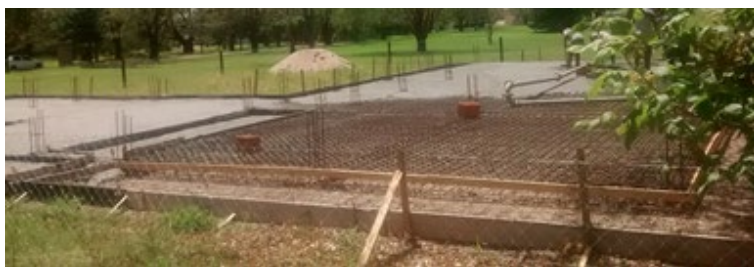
Construcción de una platea en proyecto de vivienda. Colado de hormigón
